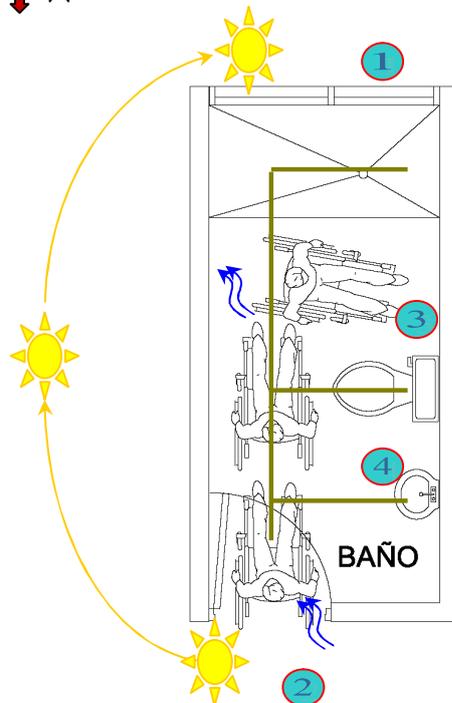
Planta Arquitectónica de Servicios Sanitarios en pabellón de mujeres
